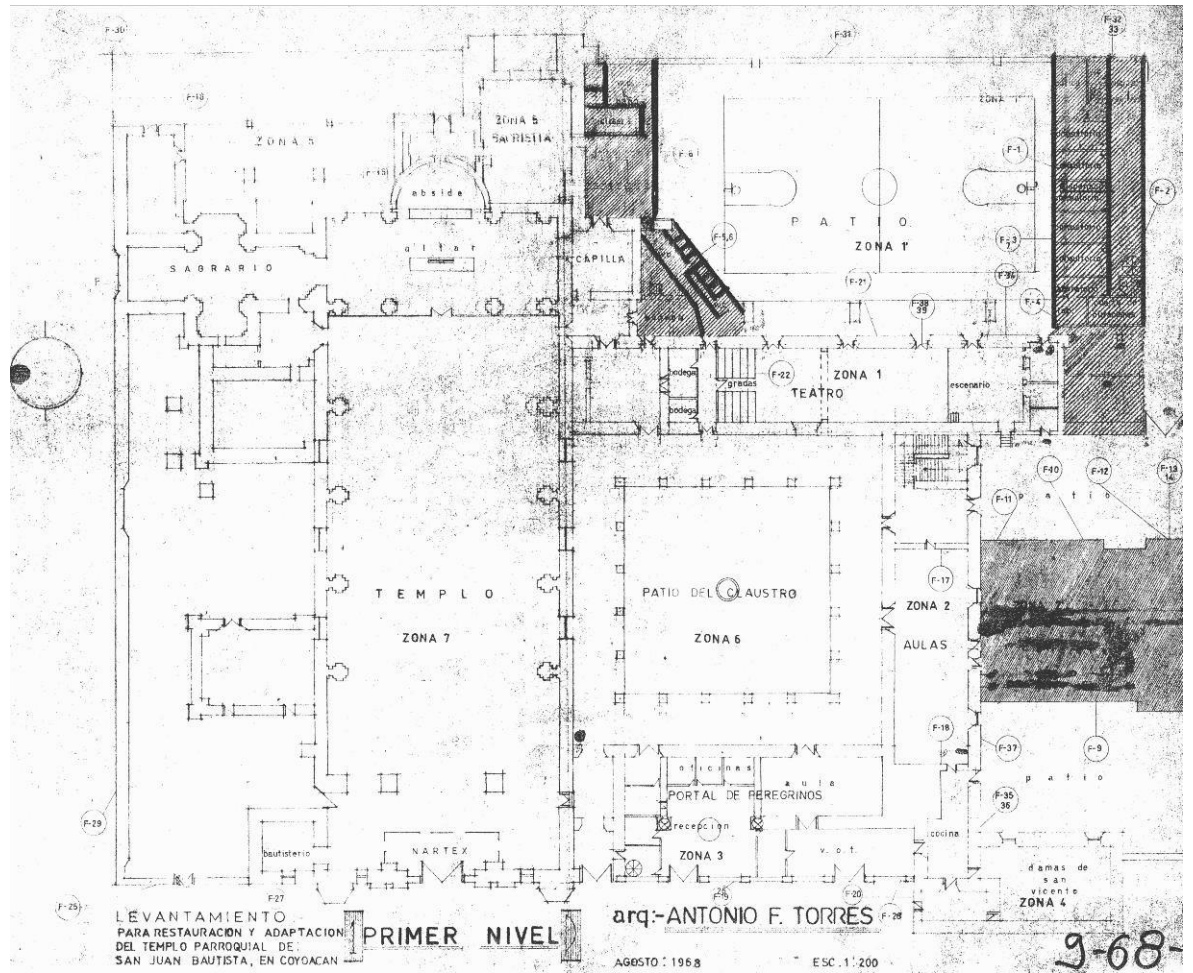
Levantamiento realizado para el proyecto de restauración y adaptación para el convento de San Juan Bautista, planta primer nivel (planta baja), agosto de 1968.⁶⁰¹
